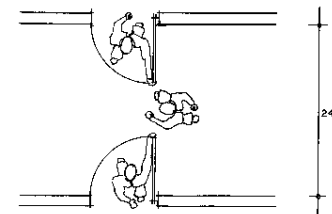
Ancho mínimo libre de pasillo para el tránsito de una persona con obstrucciones a los costados.
